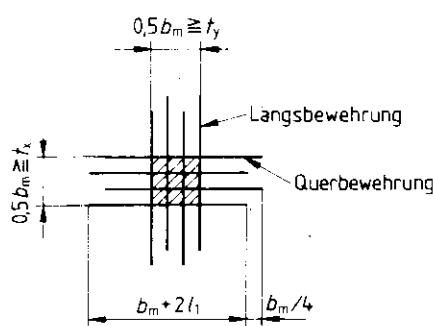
Zusätzliche Bewehrung unter einer Einzellast
